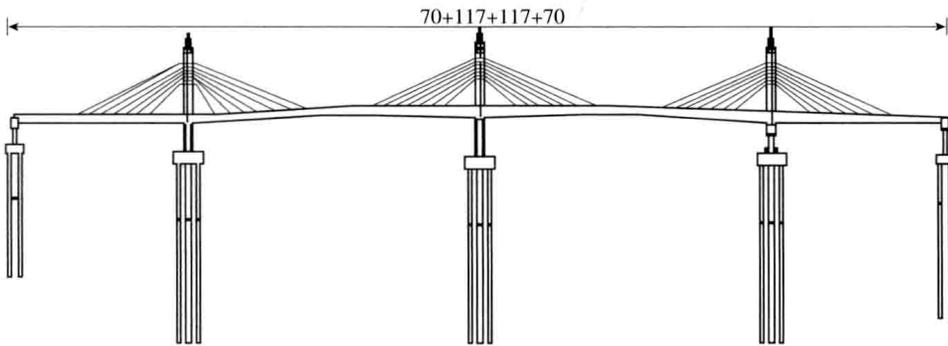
纳金大桥立面布置图(尺寸单位:m)
